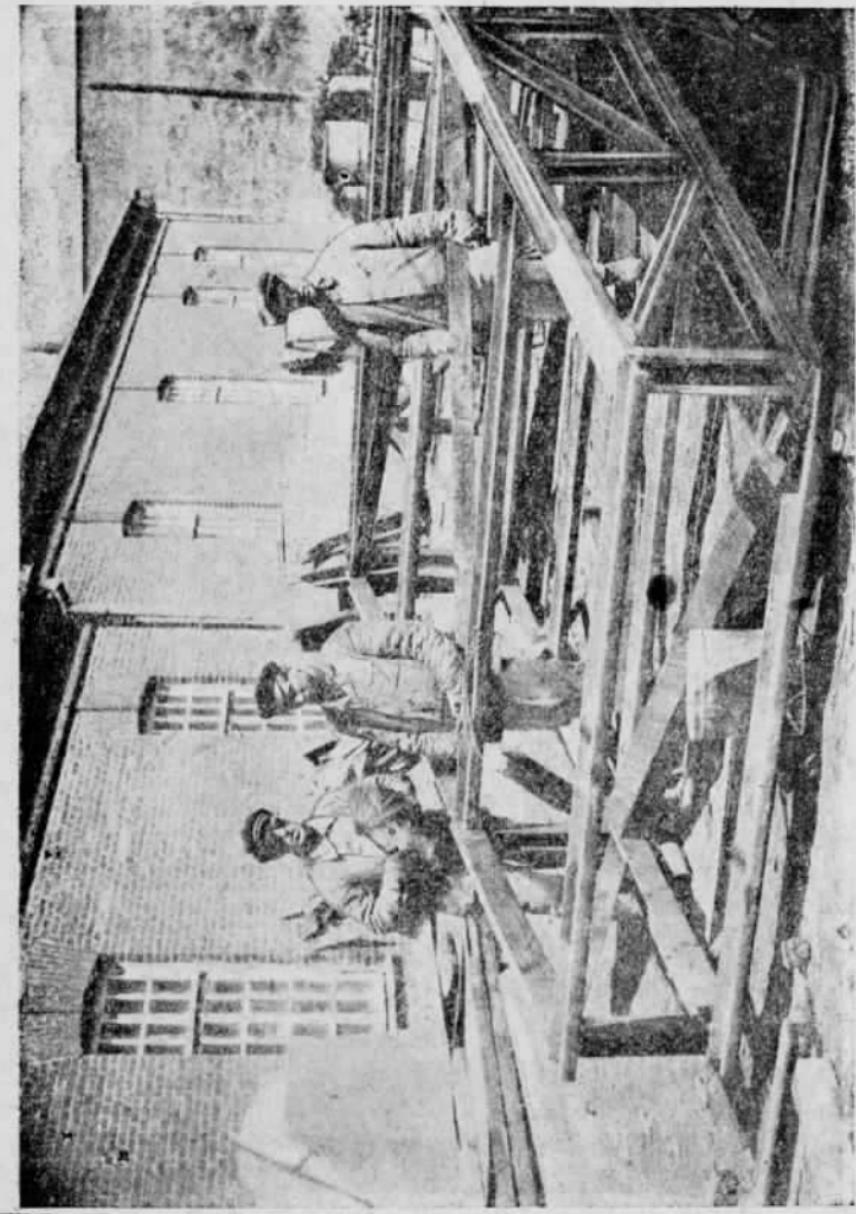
Сварка опорной башни под эстакадную ферму, представленную на рис. 86.
